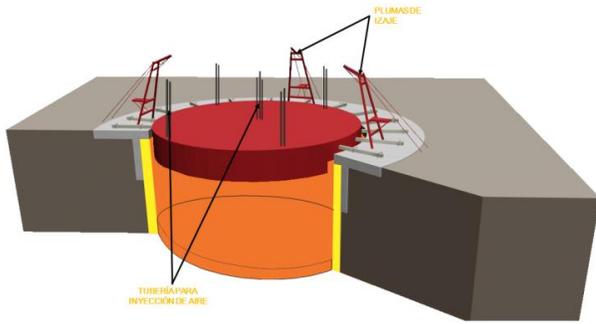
Preparación del tanque metálico para los colados de losa de fondo y muro estructural.
